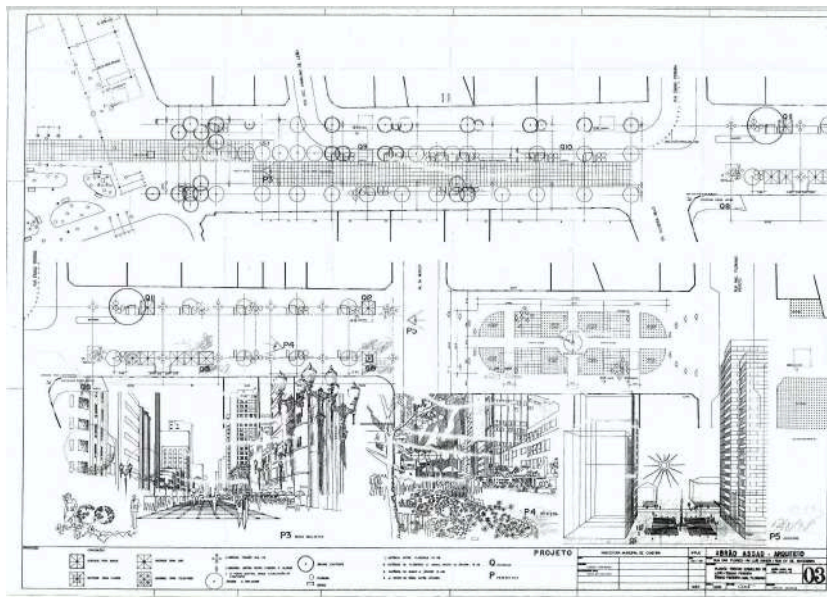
Projeto original com planta baixa e croquis da Rua da Flores. Fonte: IJL, 1974.
